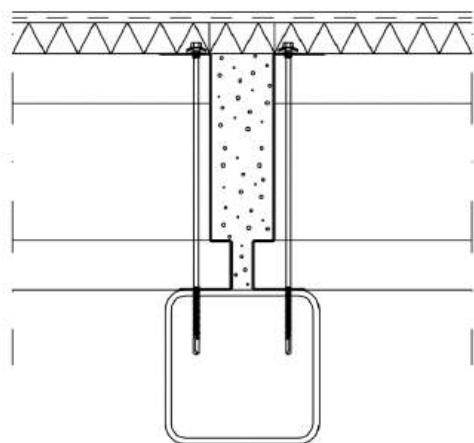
Assemblage entre les panneaux sandwich de longue portée et la structure primaire [31]
